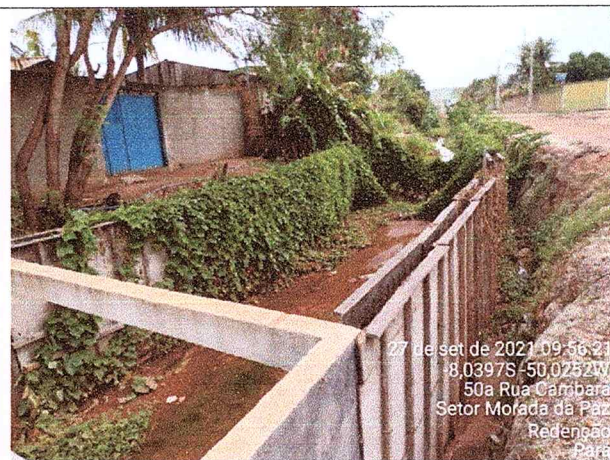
Casas próximas ao perímetro da obra e Vista do local onde será construído canal em calha de concreto moldado "in loco", já com as ferragens das paredes, as formas serão novamente executadas.
